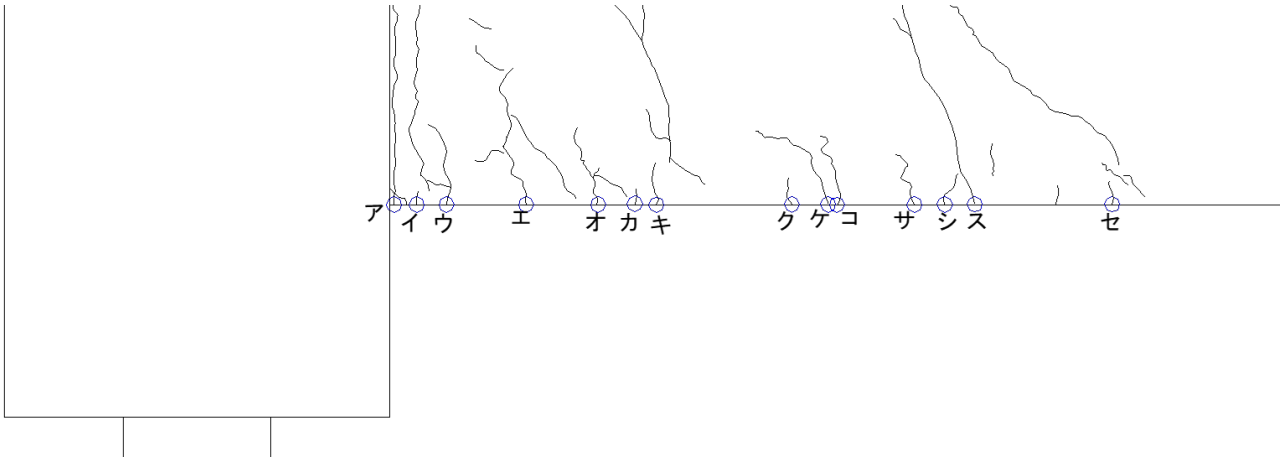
基礎梁ひび割れ幅測定位置(試験体 A-1 正載荷)
